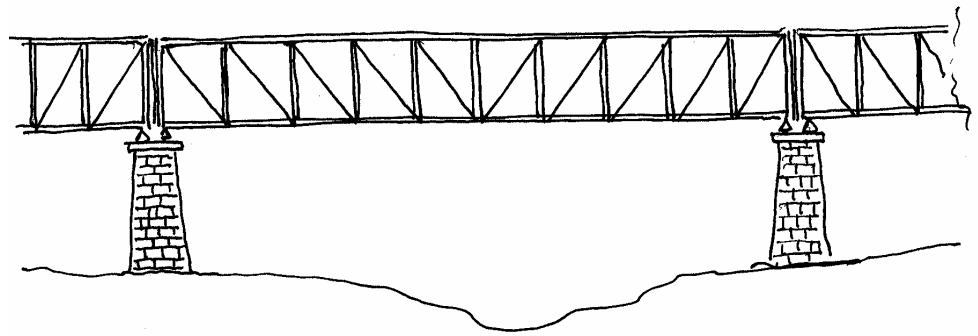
Puente celosía (metálico) o de tramo recto y canto constante. Normalmente este tipo de puentes tiene pilas y cimentaciones de fábrica.
